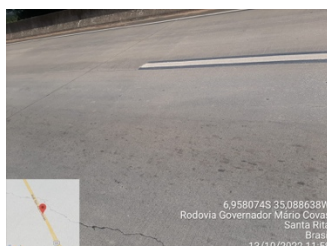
Fissura longitudinal (AUTORES 2023).
